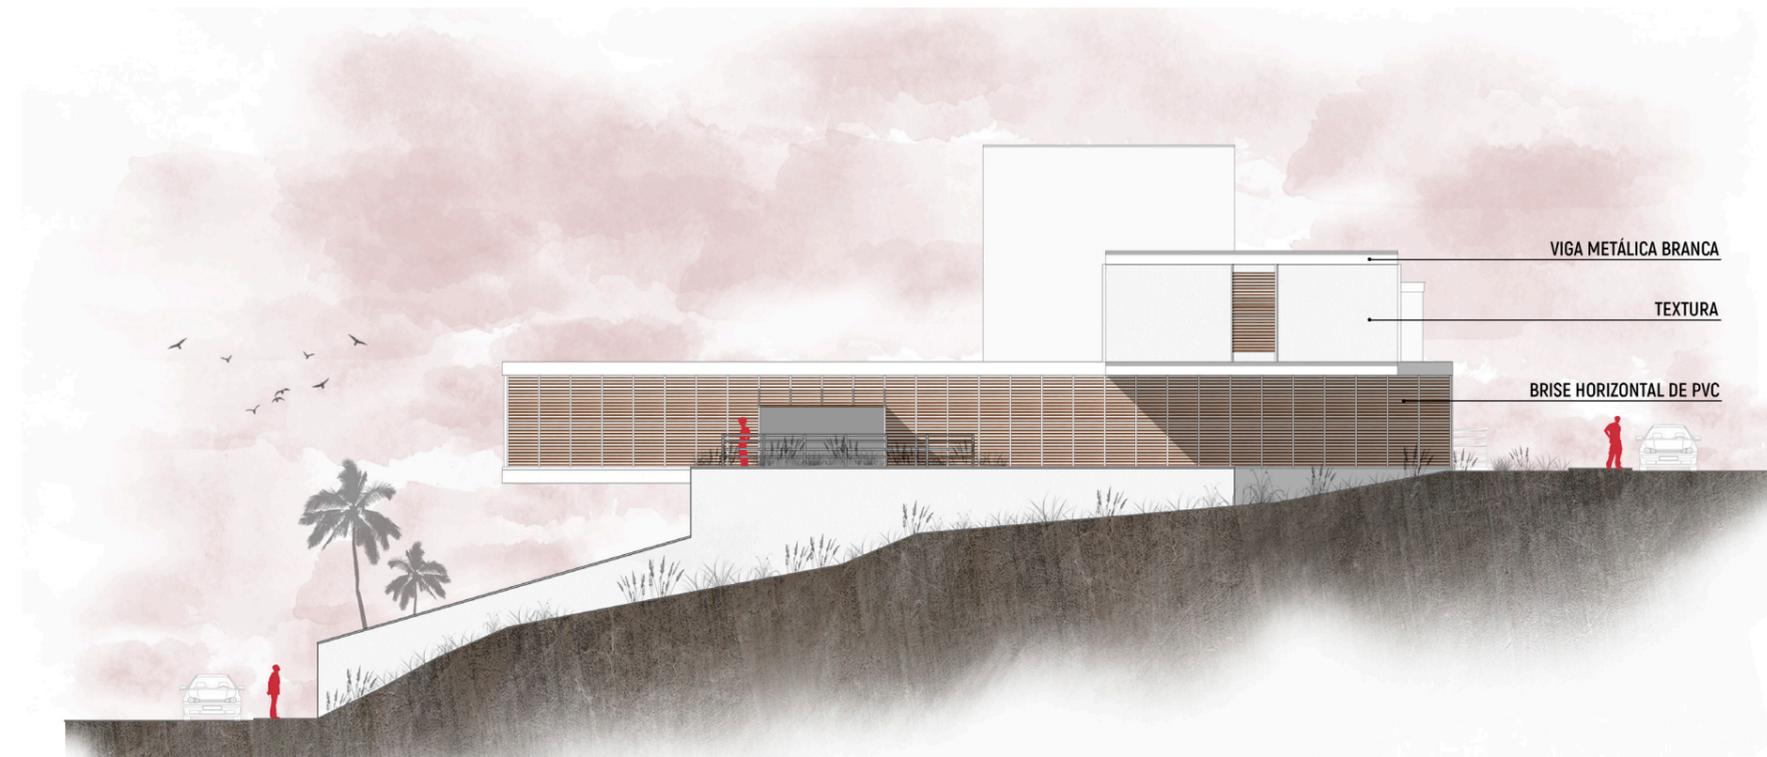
Fachada Oeste – Vista 04. Fonte:Autoral. Projeto | 145
